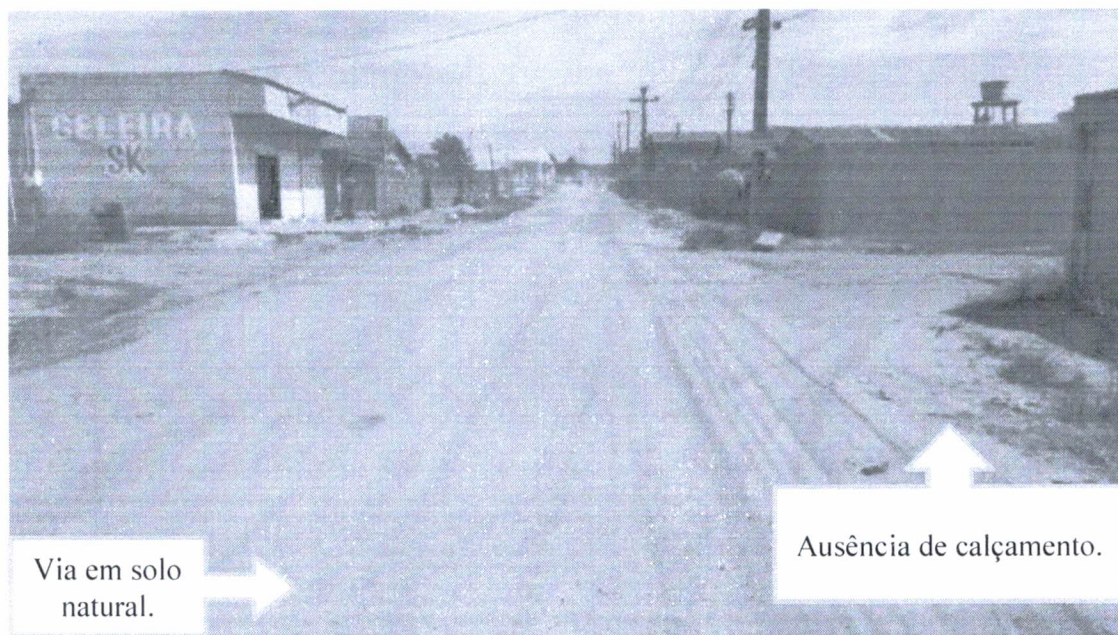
Trecho da Rua Nelson Lauer com Travessa Platina (Aristides Lopes).
